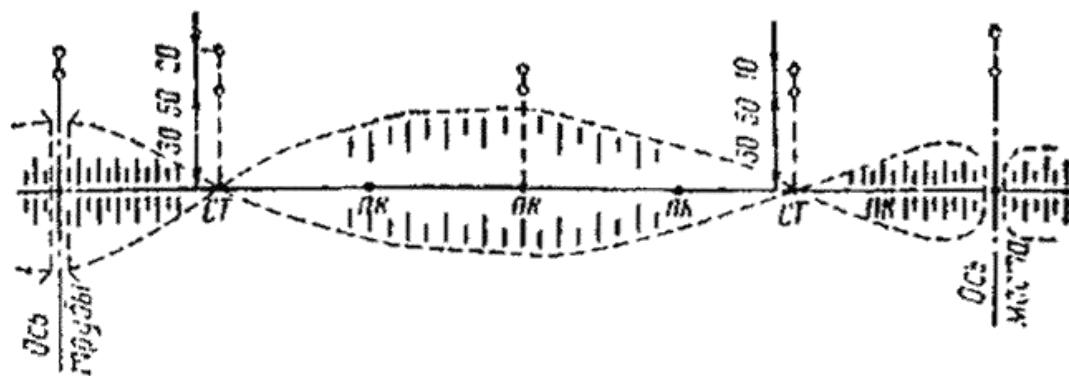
Схема закрепления основных точек трассы за зоной строительных работ
